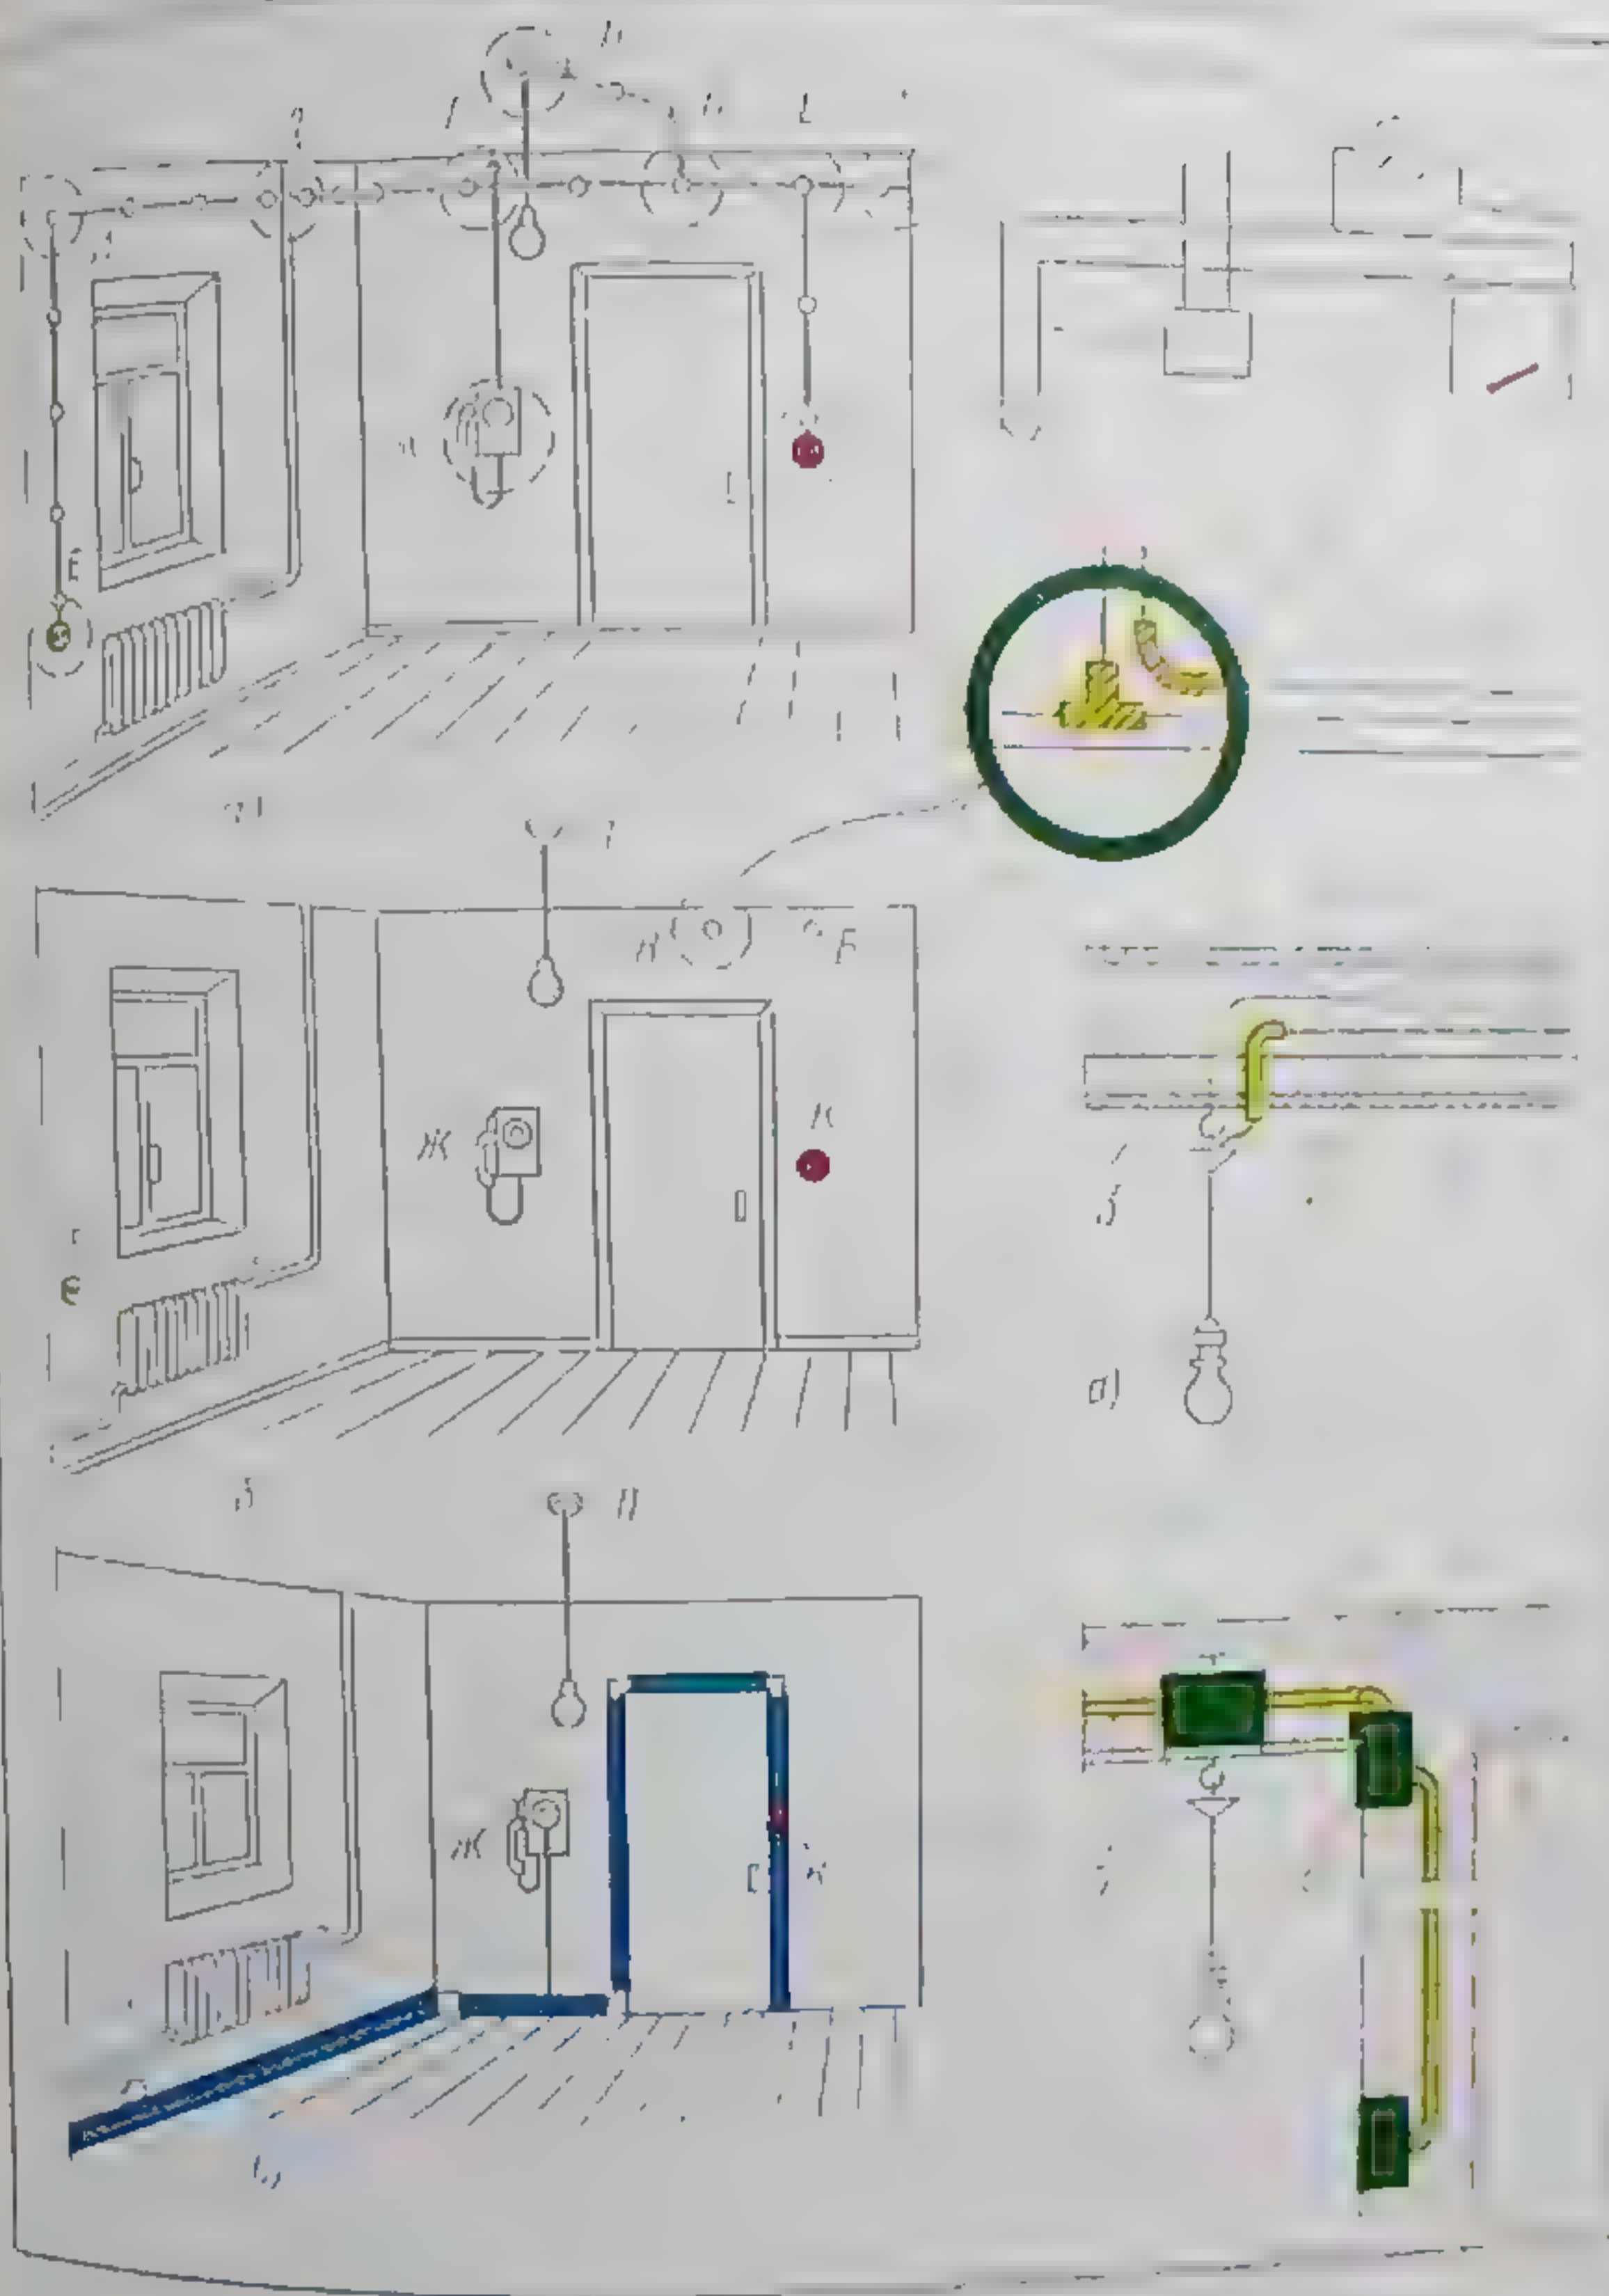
Основные узлы электропроводки: а) открытая проводка на роликах или же плоскими проводами в бороздах или же в замоноличенных винипластовых трубах; б) открытая проводка в винипластовых трубах; в) открытая проводка в винипластовых трубах; г) фрагменты скрытой проводки; д) фрагменты скрытой проводки. 1 - паркет, 2 - шлак, 3 - бетон, 4 - цемент, 5 - штукатурка, 6 - винипластовая труба; 7 - коробка потолочная; 8 - коробка настенная.
